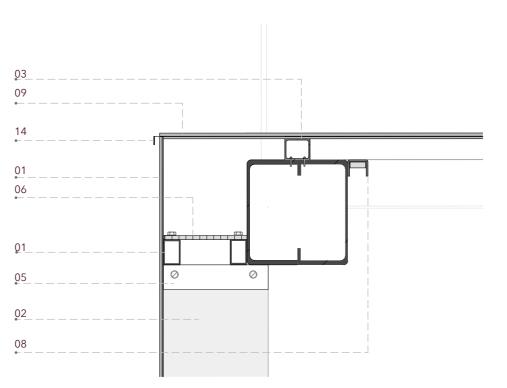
Detalle ampliación 01. Fuente: Elaboración propia
